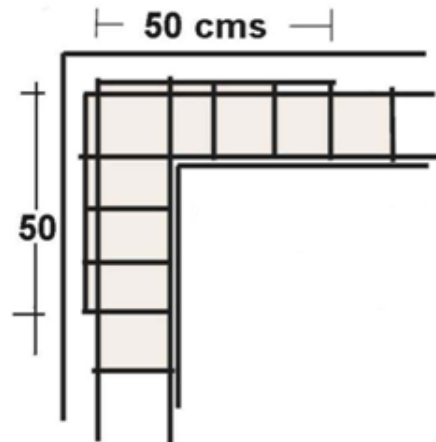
Detalle del anclaje de las barras longitudinales de las cadenas en el encuentro con un pilar de esquina, encuentro en L (SENA, 2003)
